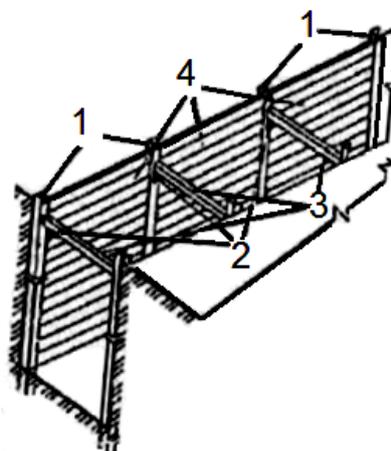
Инвентарное распорное крепление стен траншей и котлованов для прокладки ПВТНК из ВЧШГ
